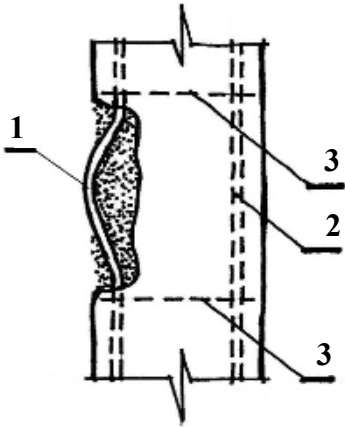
Схема руйнування залізобетонного елемента в стиснутій зоні бетону при втраті стійкості стержнями стиснутої арматури: 1 – поздовжня стиснута арматура; 2 – поздовжня розтягнута арматура; 3 – поперечна арматура
